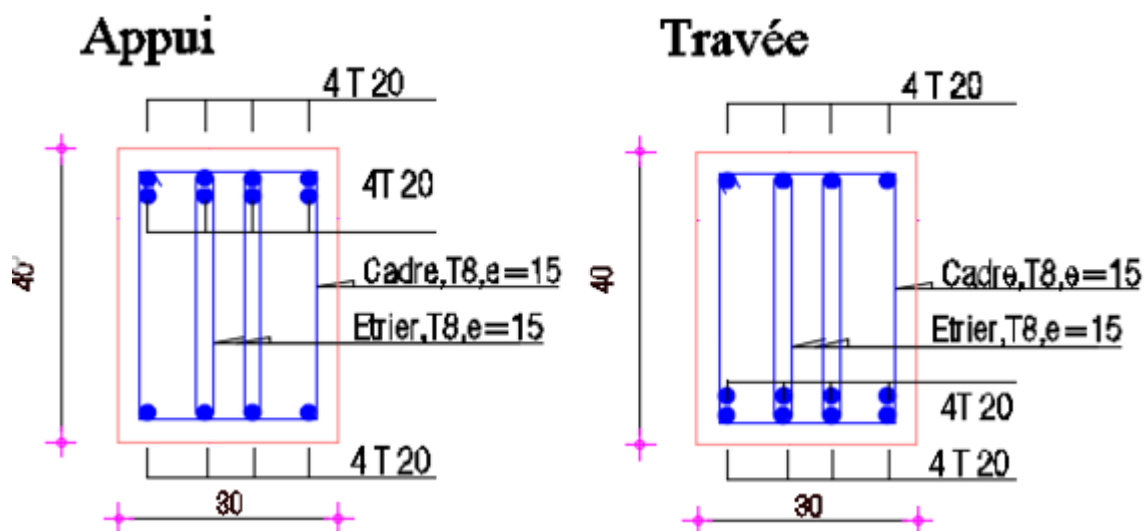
Ferrailage des poutre secondaire usage habitation
